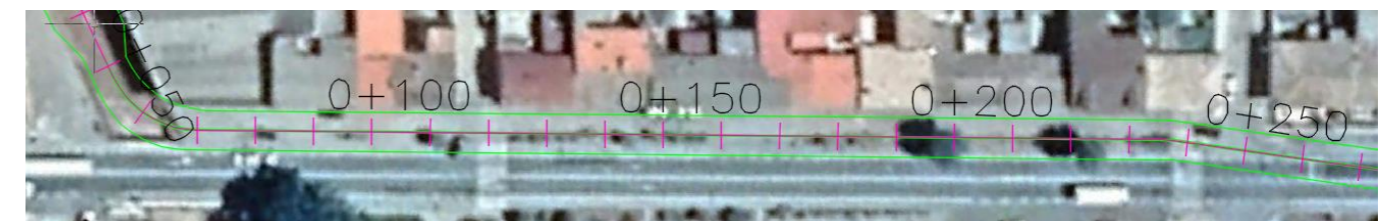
Tramo 1 en planta. Fuente: Propia.
